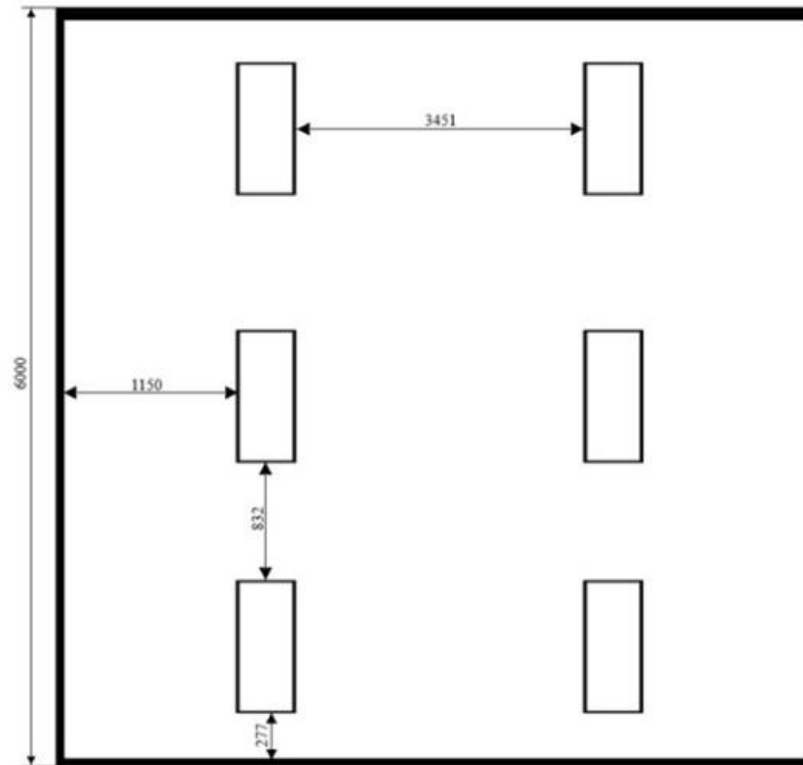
План помещения и размещения светильников со светодиодными лентами
